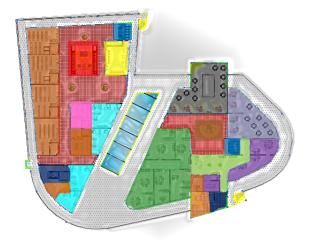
Plan de 1^{er} étage. Source : Auteur
